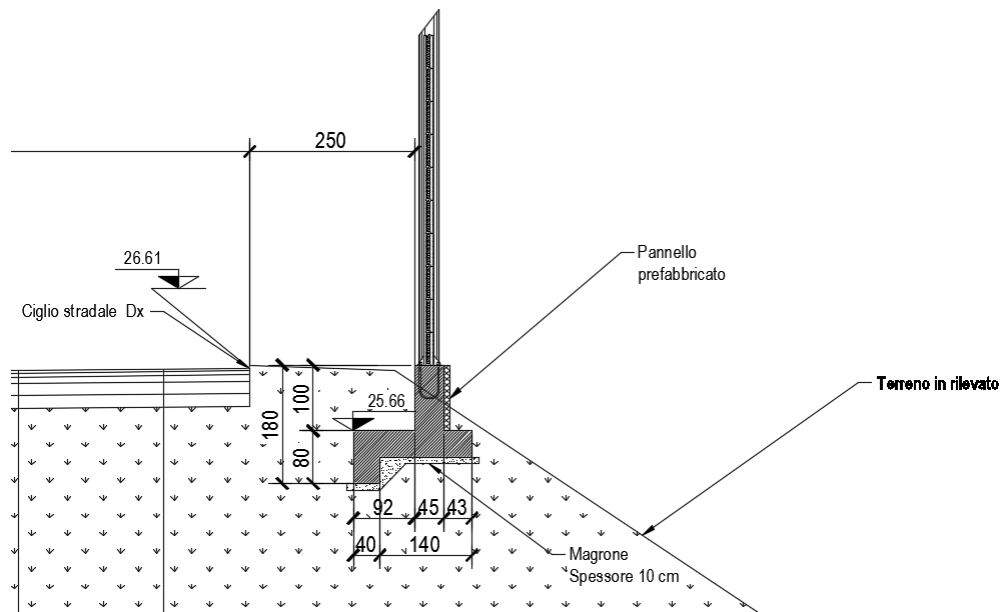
Sezione trasversale del muro di fondazione per barriera fonoassorbente in rilevato (TIPO 2).
